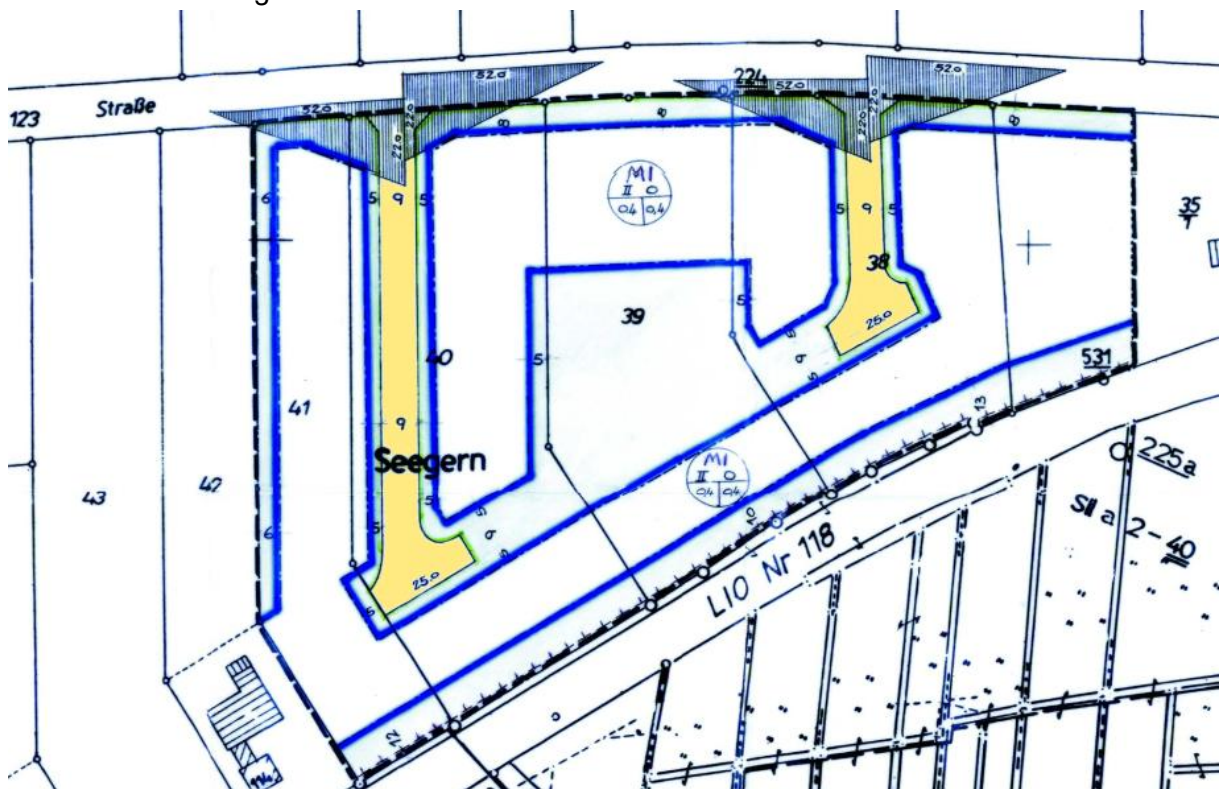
Bebauungsplan Nr. 6 (Ausschnitt).
